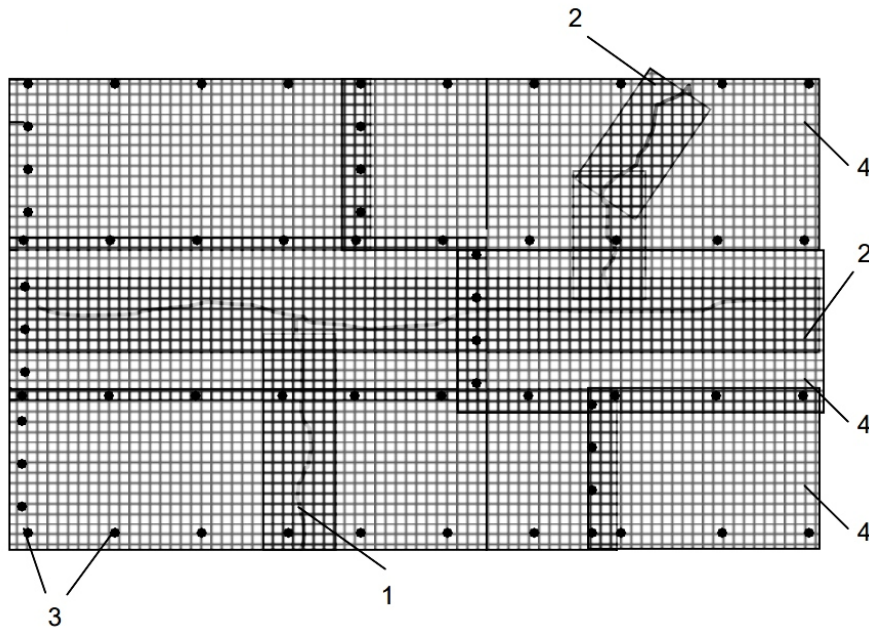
Схемы укладки и крепления полотен и полос геосетки на основании при комбинированном армировании полосами и сплошным полотном: 1 – продольные и поперечные трещины; 2 – полосы геосетки; 3 – дополнительная фиксация полос к основанию; 4 – полотна геосетки, укладываемые поверх полос.
